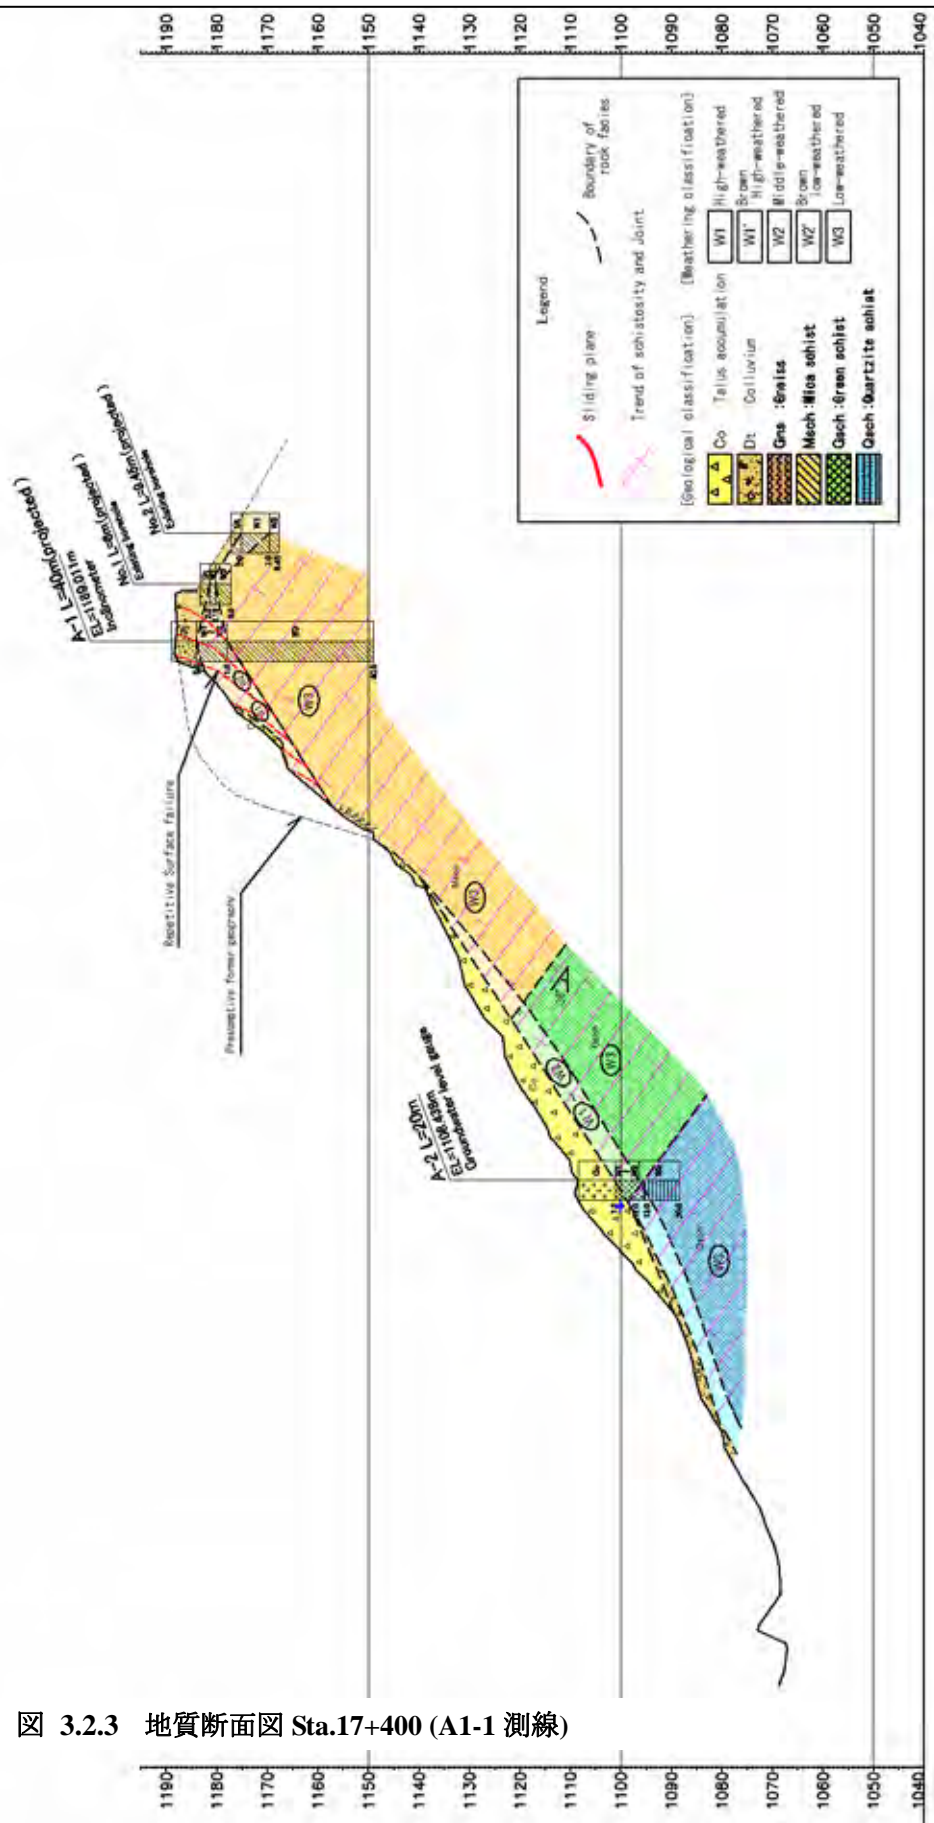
地質断面図 Sta.17+400 (A1-1 測線)
